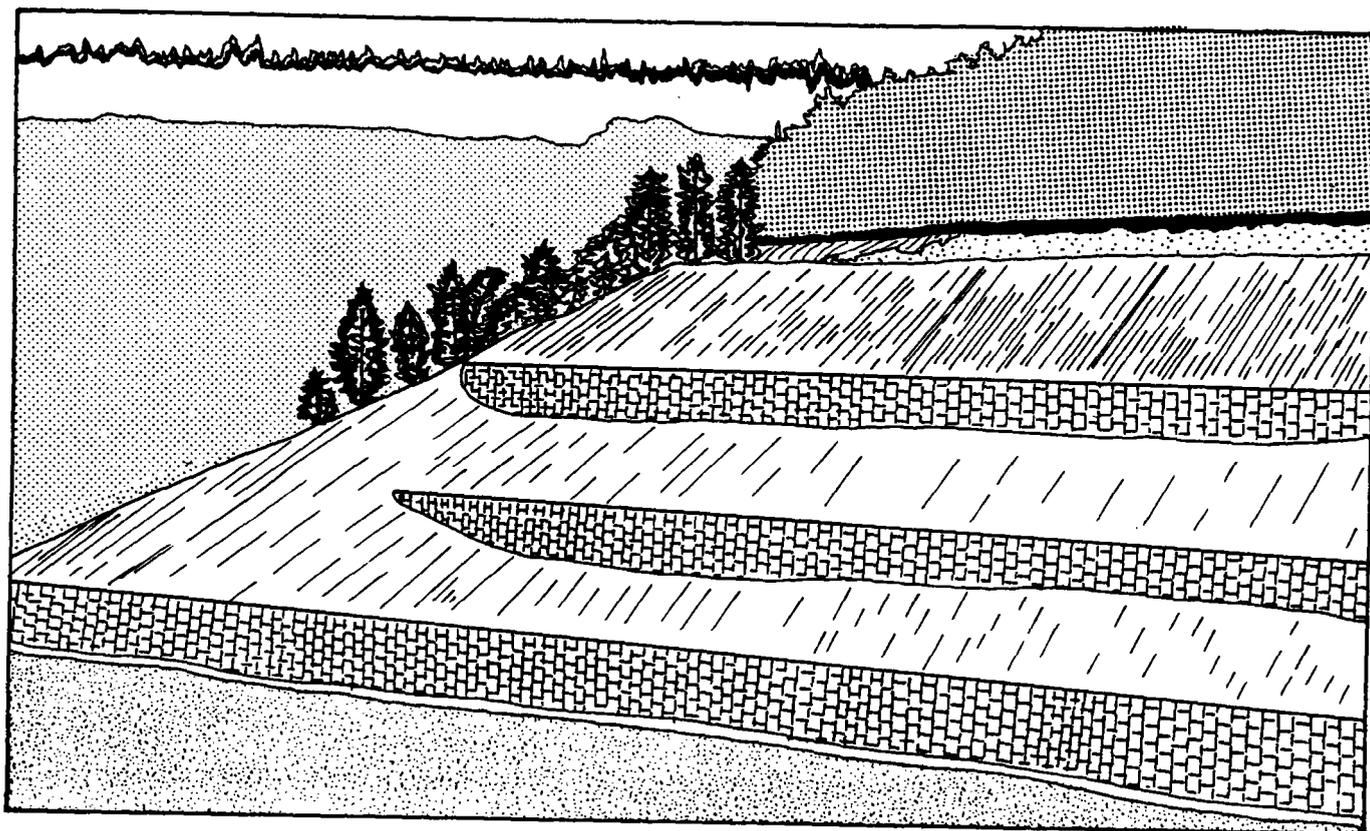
Stabilisation d'un talus par trois niveaux de massifs en terre armée pour le passage d'une autoroute dans la forêt de SAVERNE (Vosges).
